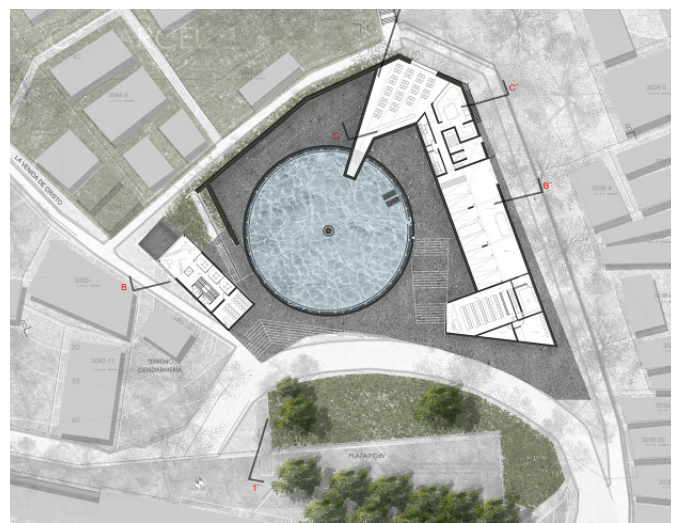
Proyecto en planta. Cristóbal Vial Arquitectos.
